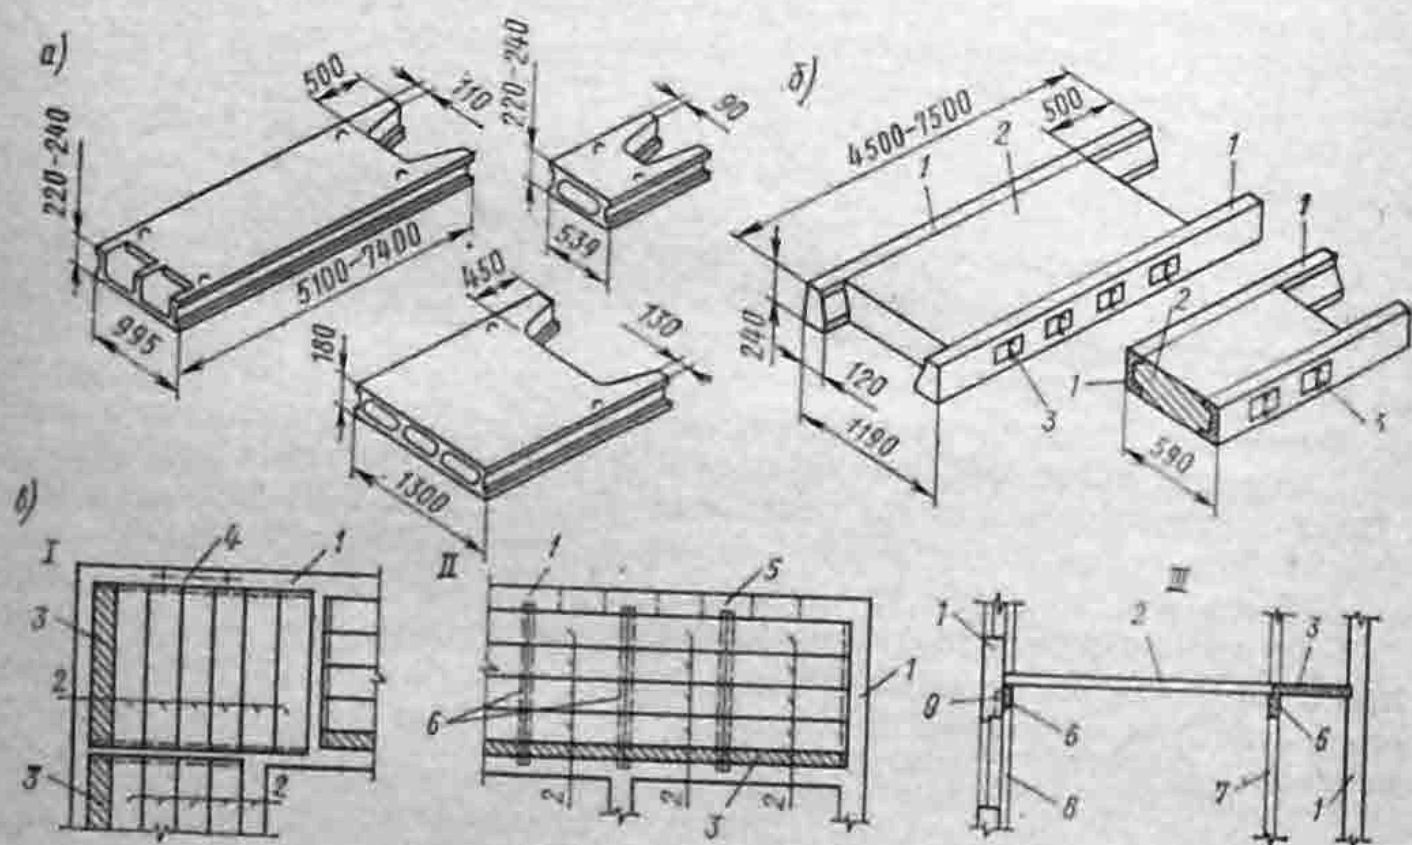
Большеобъемные плиты перекрытий, применяемые для ремонта:
